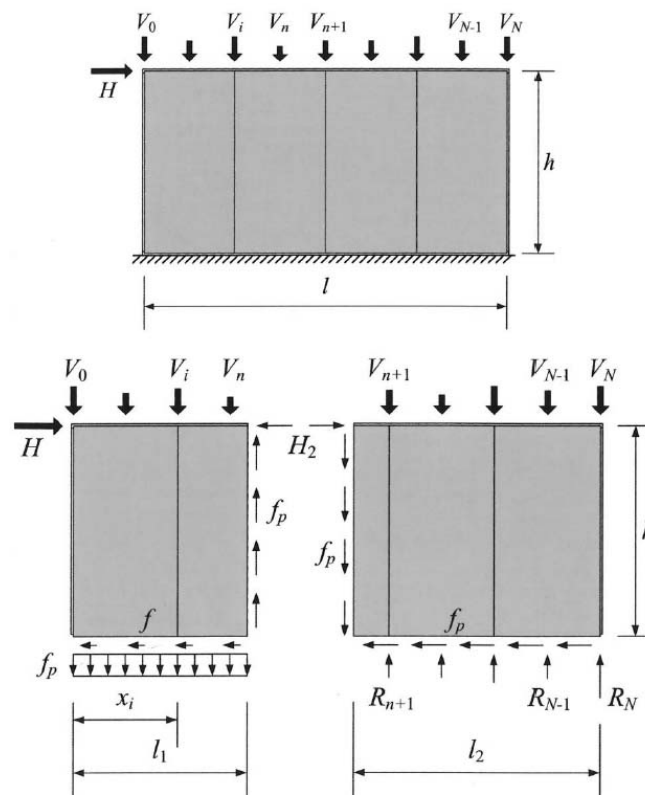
Kraftfördelning på regler i skivbekladd vägg. (Källsner och Girhammar 2008).
